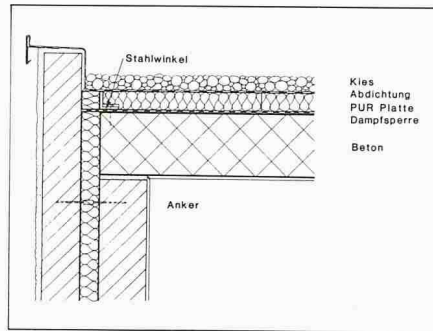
Auf der Betondecke fixierter Stahlwinkel zur Ableitung der Druckkräfte
